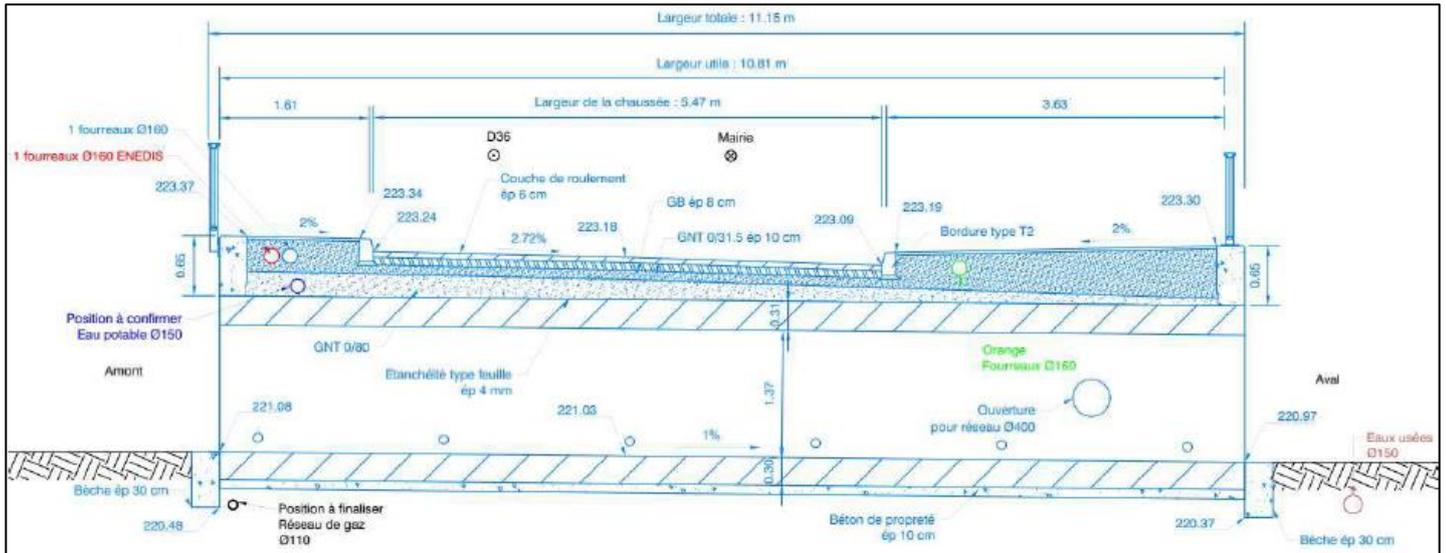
Projet pont des Allobroges : Coupe transversale à la chaussée
